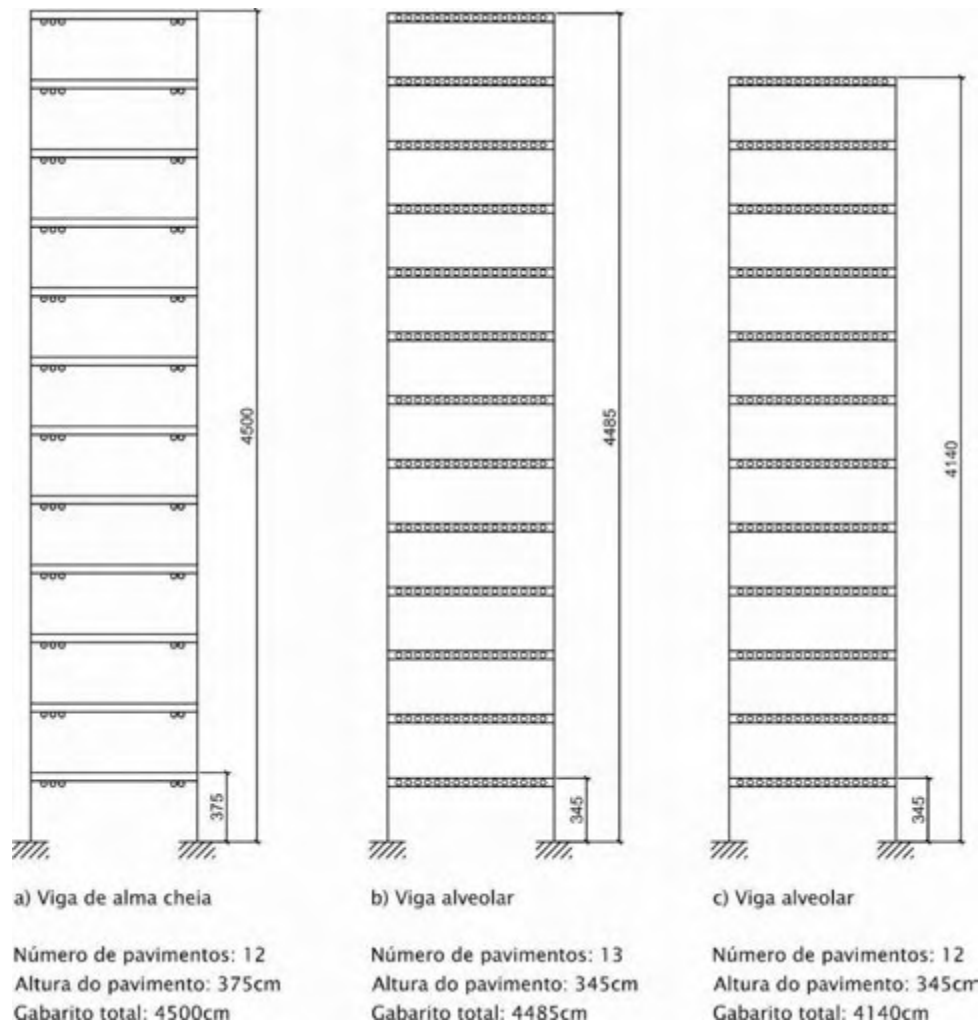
Exemplo comparativo: alternativas com viga alveolar e viga de alma cheia.
